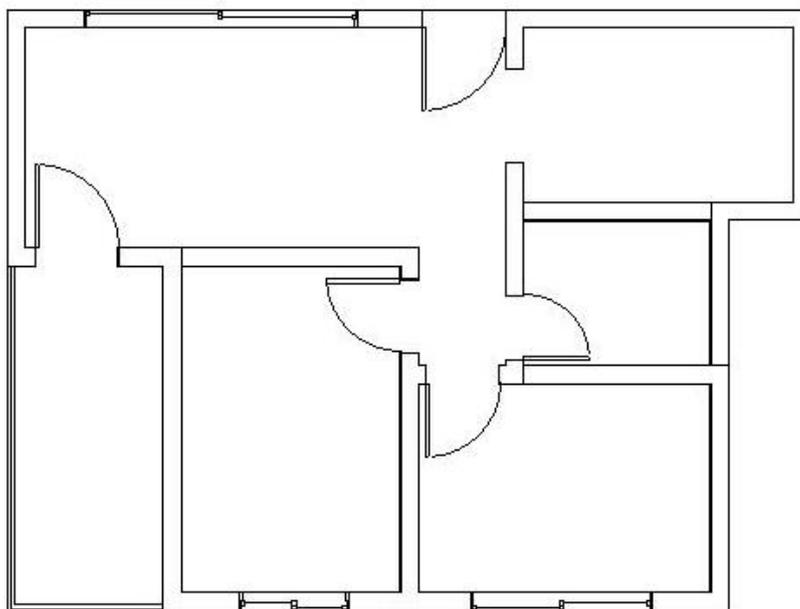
Planta Baixa - Inclusão do Guarda-Corpo
